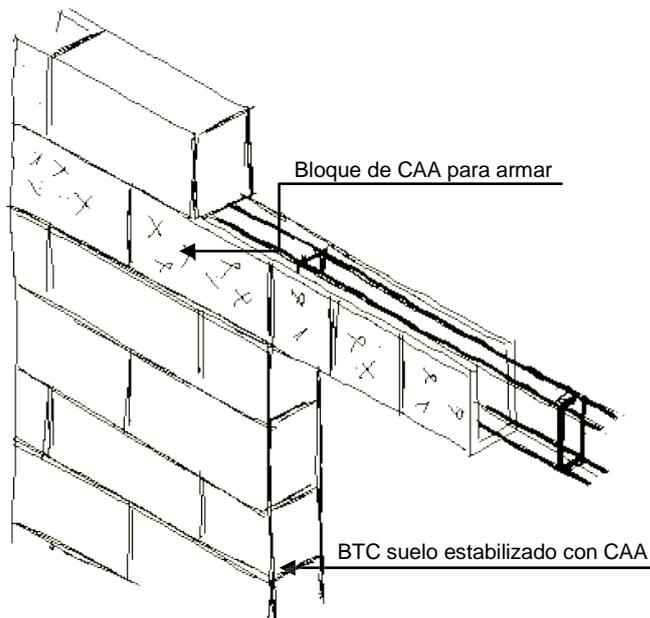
Muro de cerramiento ejecutado con BTC de suelo estabilizado con CAA. Dintel de bloque prefabricado de hormigón de CAA para armado
